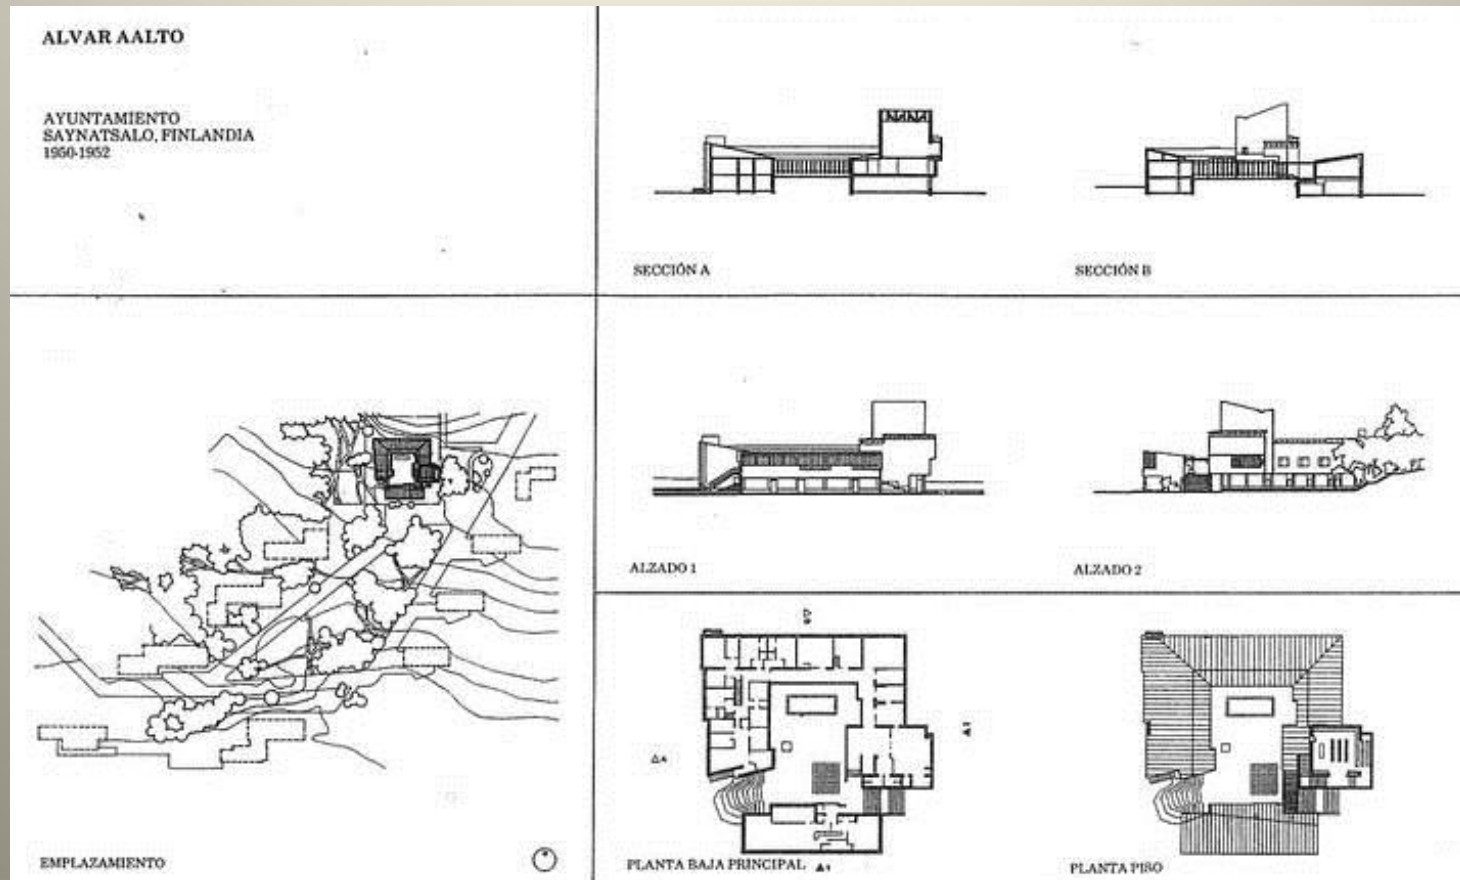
Implantação, Planta, Corte e Elevação - Câmara Municipal de Saynatsalo (pág. 8)
